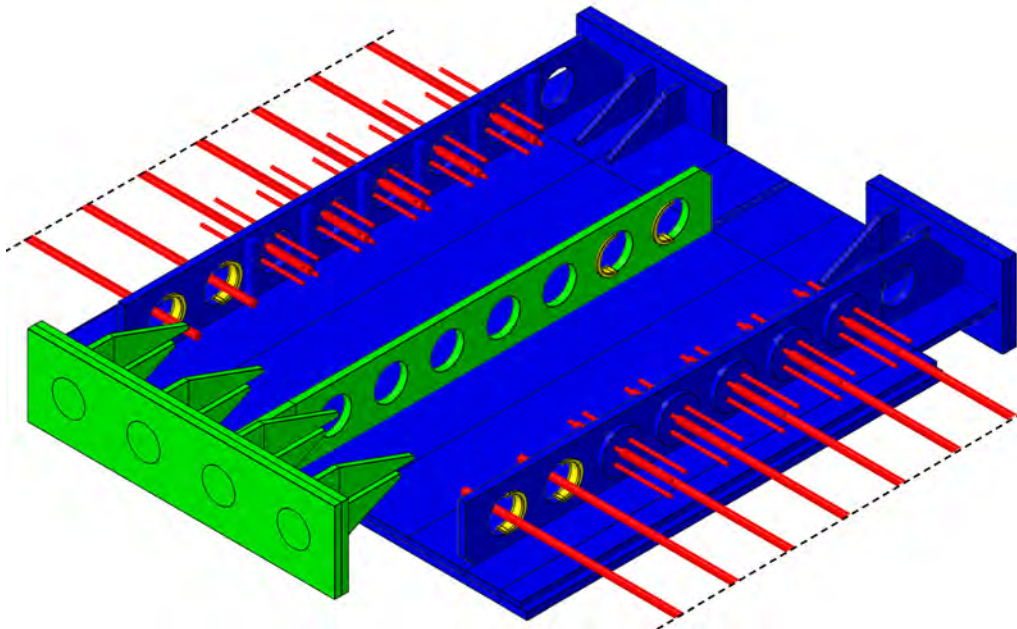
Versuchskörper VK1/2, mit Zug, ohne Bewehrung
